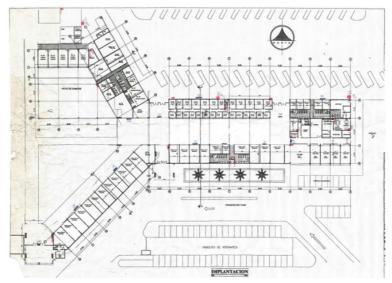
3: Plano terminal terrestre Elaborado por: Autor
